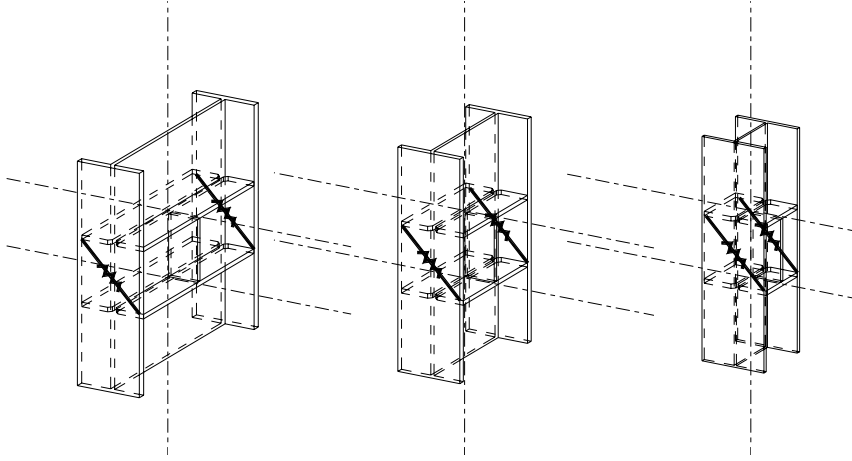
I-Bölgesi üzerinde etken iç kuvvetler.
